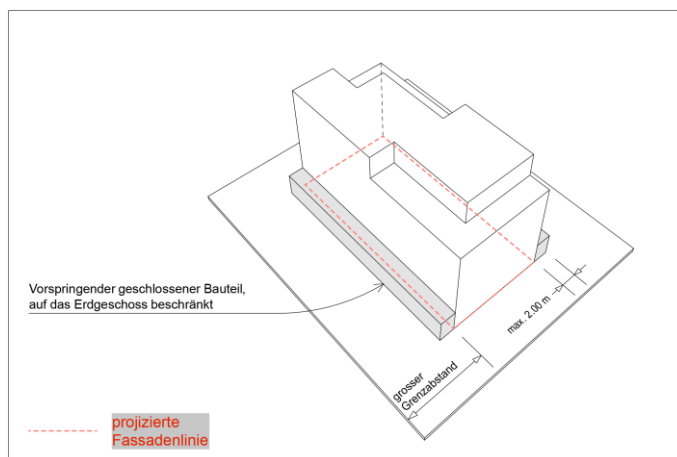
Bisher: Vorspringender geschlossener Bauteil auf das Erdgeschoss beschränkt
